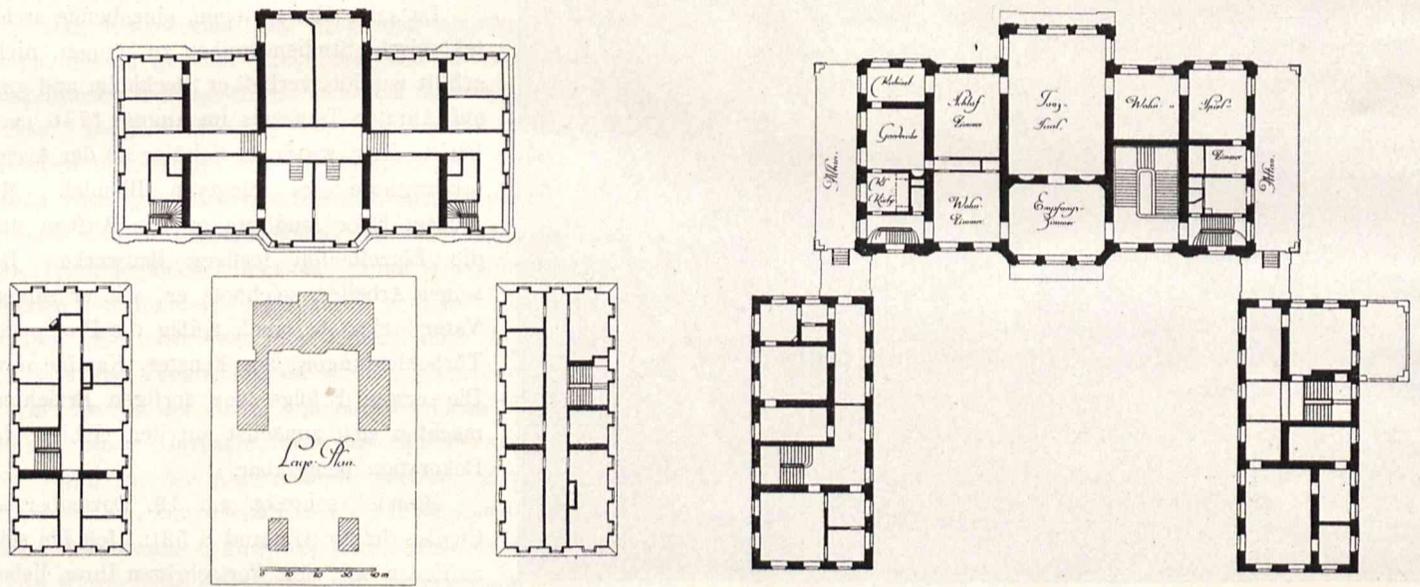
u. 4. Lageplan und Dachgeschoß.
